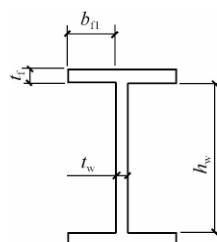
型钢混凝土梁的型钢钢板宽厚比
